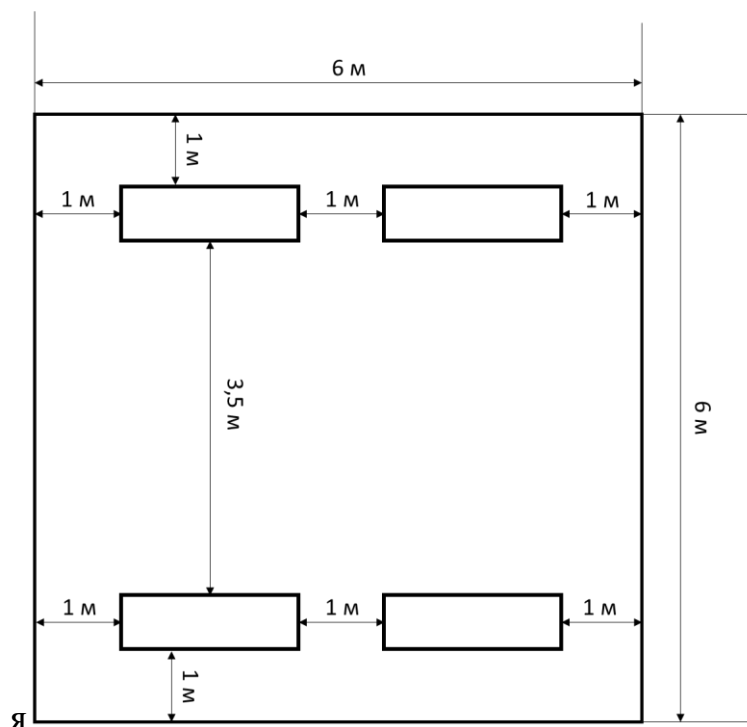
План помещения и размещения светильников с люминесцентными лампами
